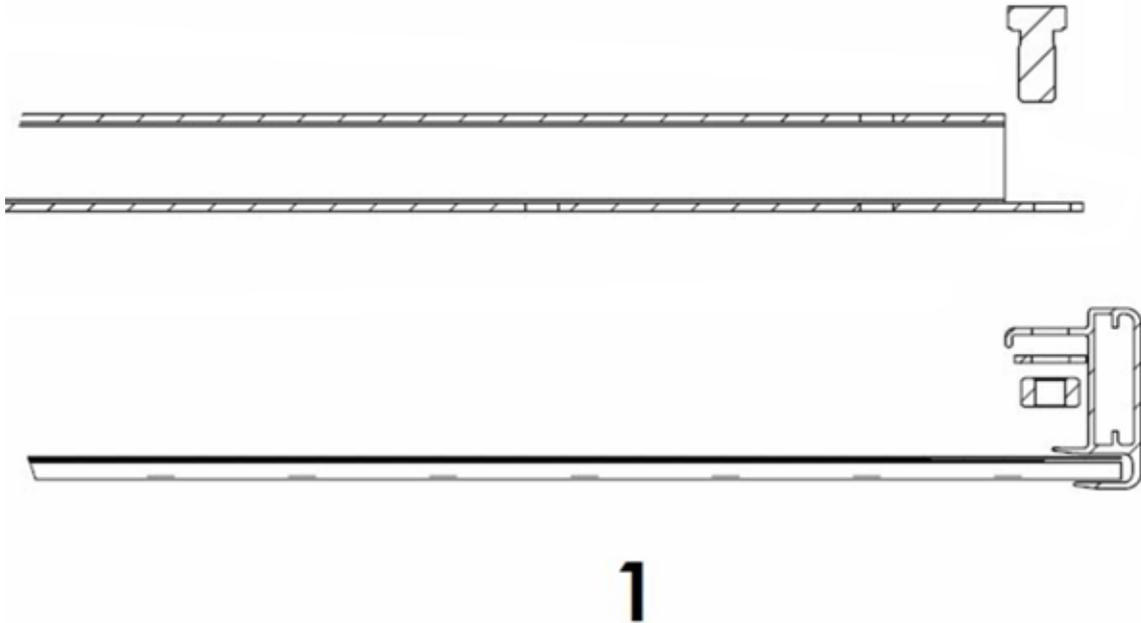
Detailansicht Backrail bzw. Modul (Schnitt) zur Montage der Backrails (Ansicht von unten)
